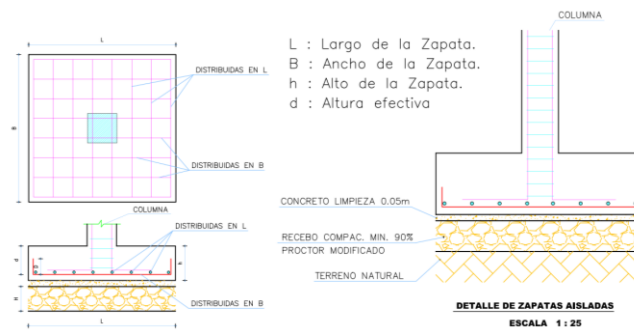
Detalle de distribución acero para zapatas. Fuente: Planos proyecto
